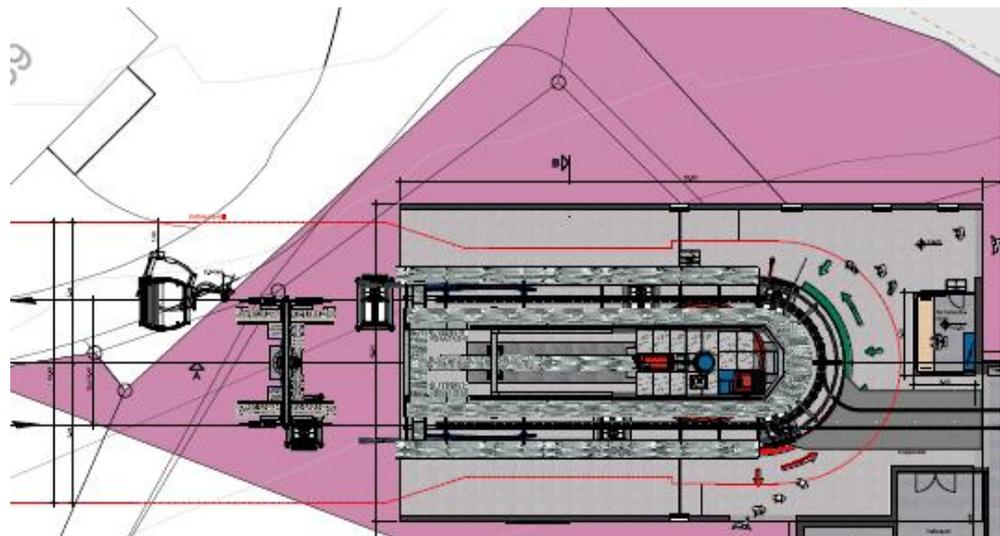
Beispiel Grundriss einer Bergstation
